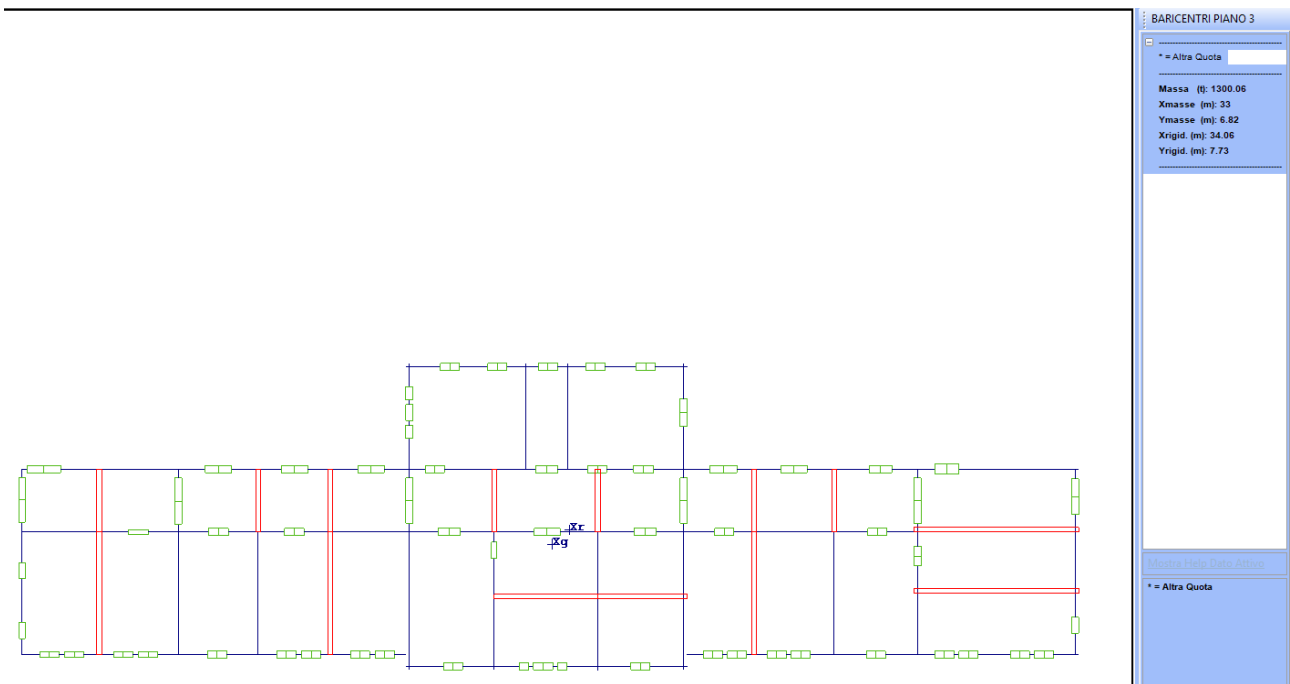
Baricentro masse e baricentro rigidezze piano copertura (piano n°3)
